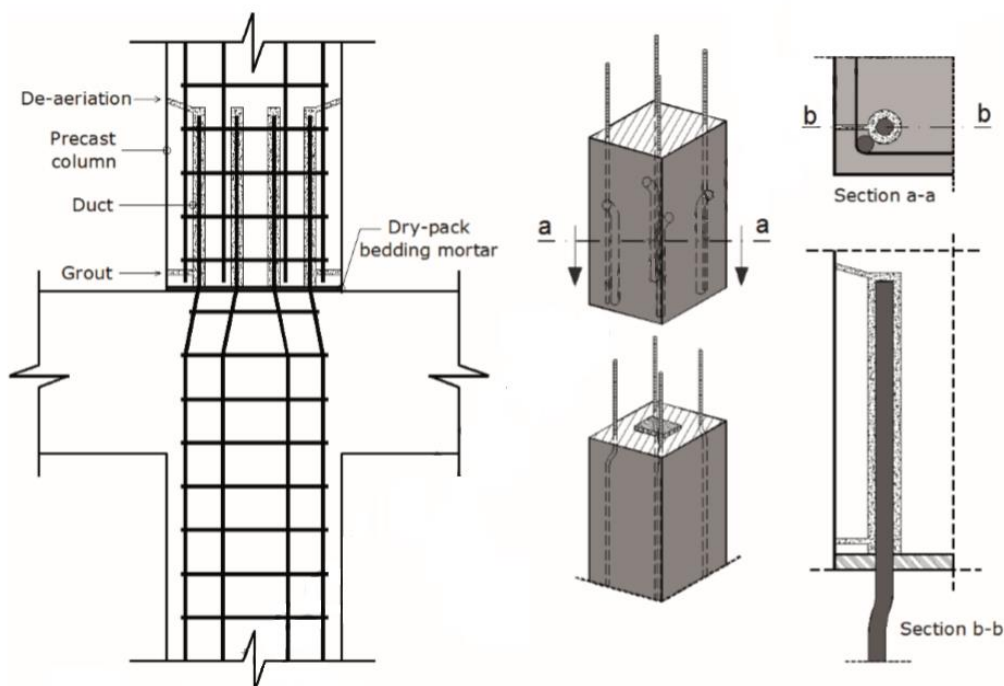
Conexión columna a columna por traslape rellenos con una lechada especial. [14]
